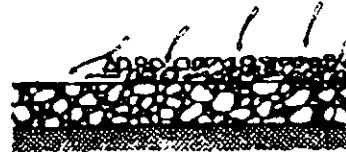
"CAPAS DE UN PAVIMENTO CON CAPA DE RODADURA DRENANTE"
